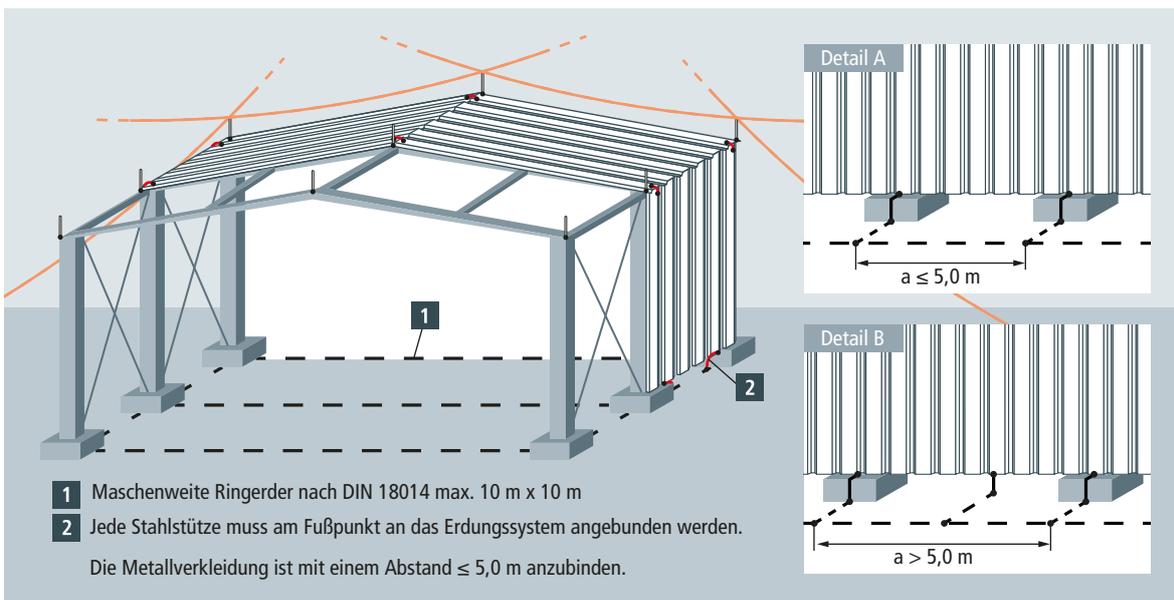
Stahlhalle mit durchgängiger Metallverkleidung
